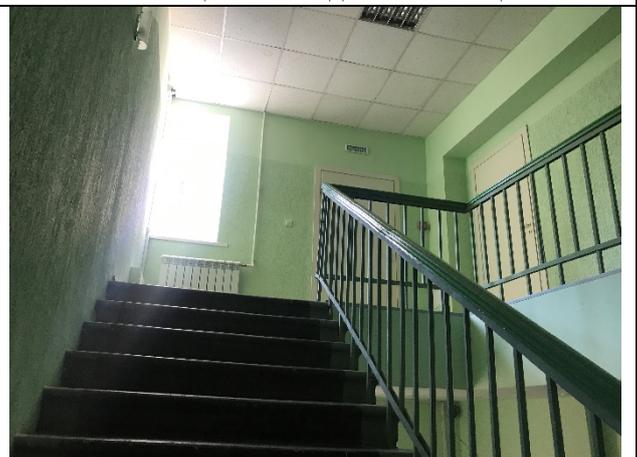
Лестница, ведущая на второй этаж здания размещения Объекта оценки.
